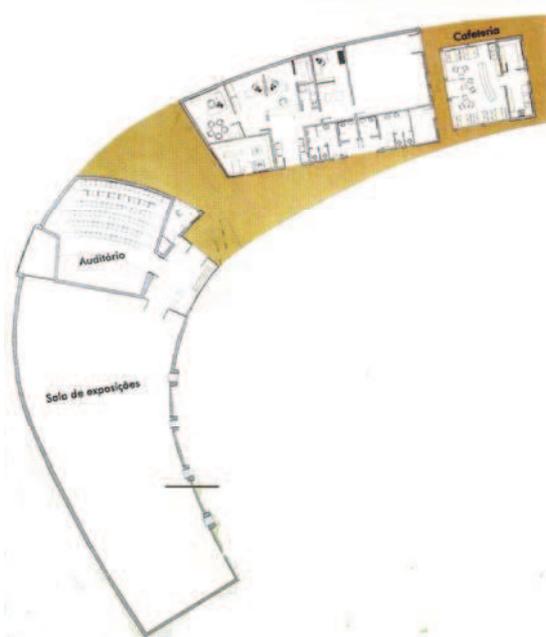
Planta Baixa da Unidade Museológica de Agudo
